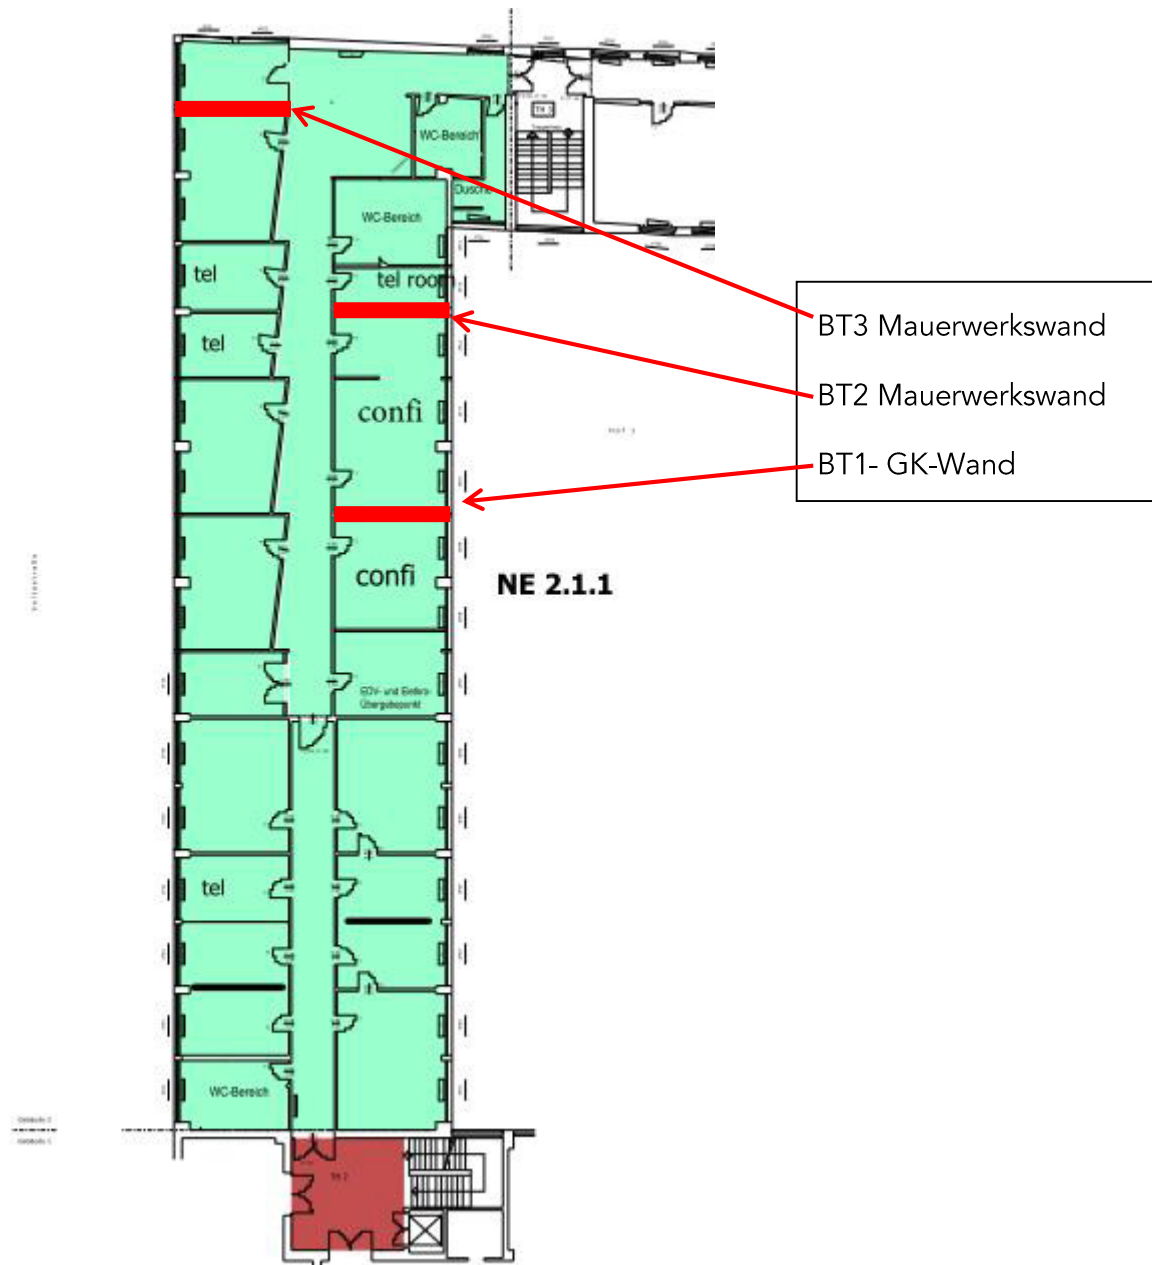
Auszug Grundriss 1.OG, markierte Bauteile
